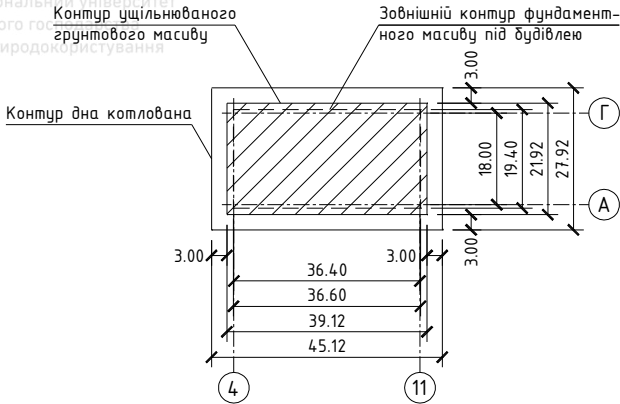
Конттури у плані фундаментного масиву під будівлею, ущільнюваного ґрунтового масиву та дна котлована
